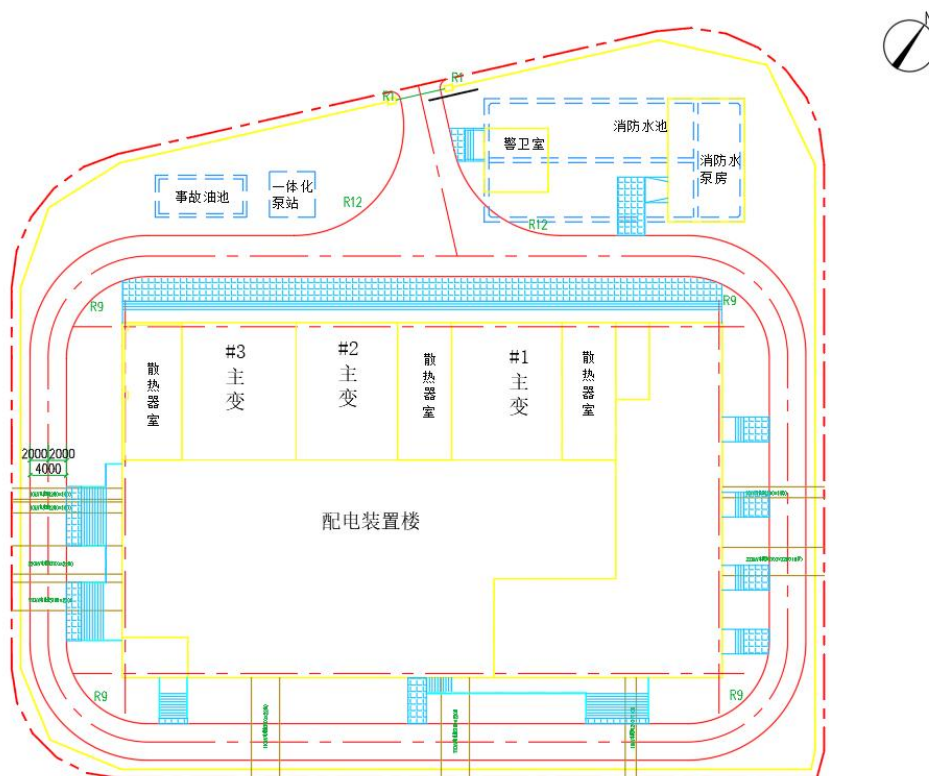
新城中心 220 千伏变电站土建总平面布置图
